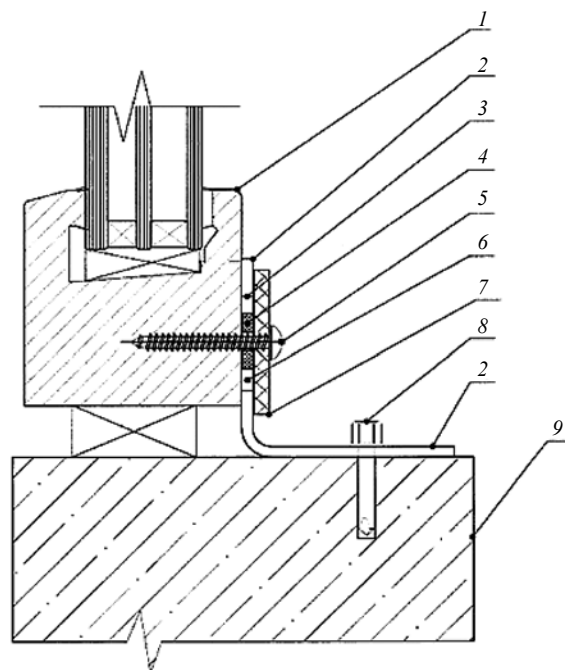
Модель ЛСК¹⁰. Общий вид конструкции: 1 — смещаемый элемент; 2 — опорный кронштейн; 3 — дистанционная шайба; 4 — отверстие в кронштейне; 5 — винт; 6 — зазор; 7 — разрушаемая шайба; 8 — крепление кронштейна к каркасу (стене) здания; 9 — стена или силовой каркас здания
